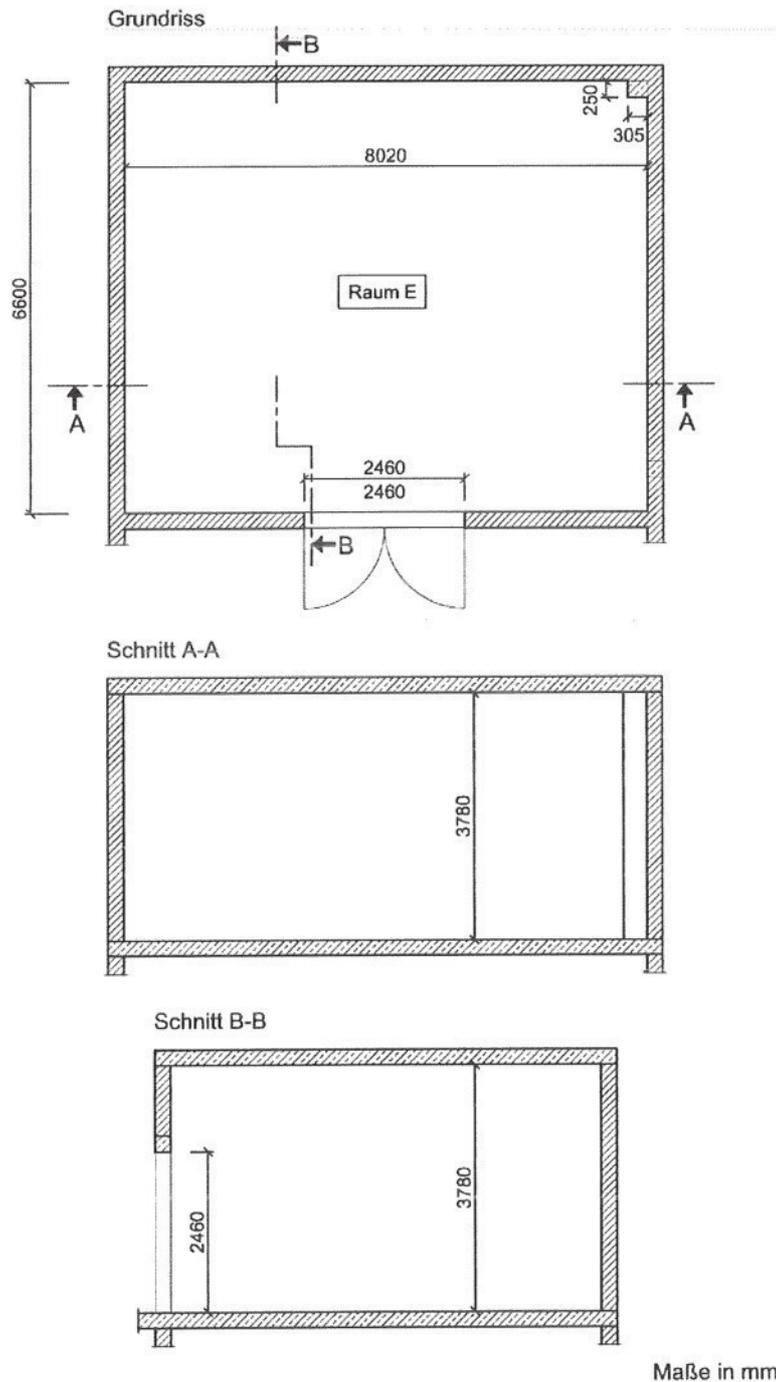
Grundriss und Schnitte des Hallraums
